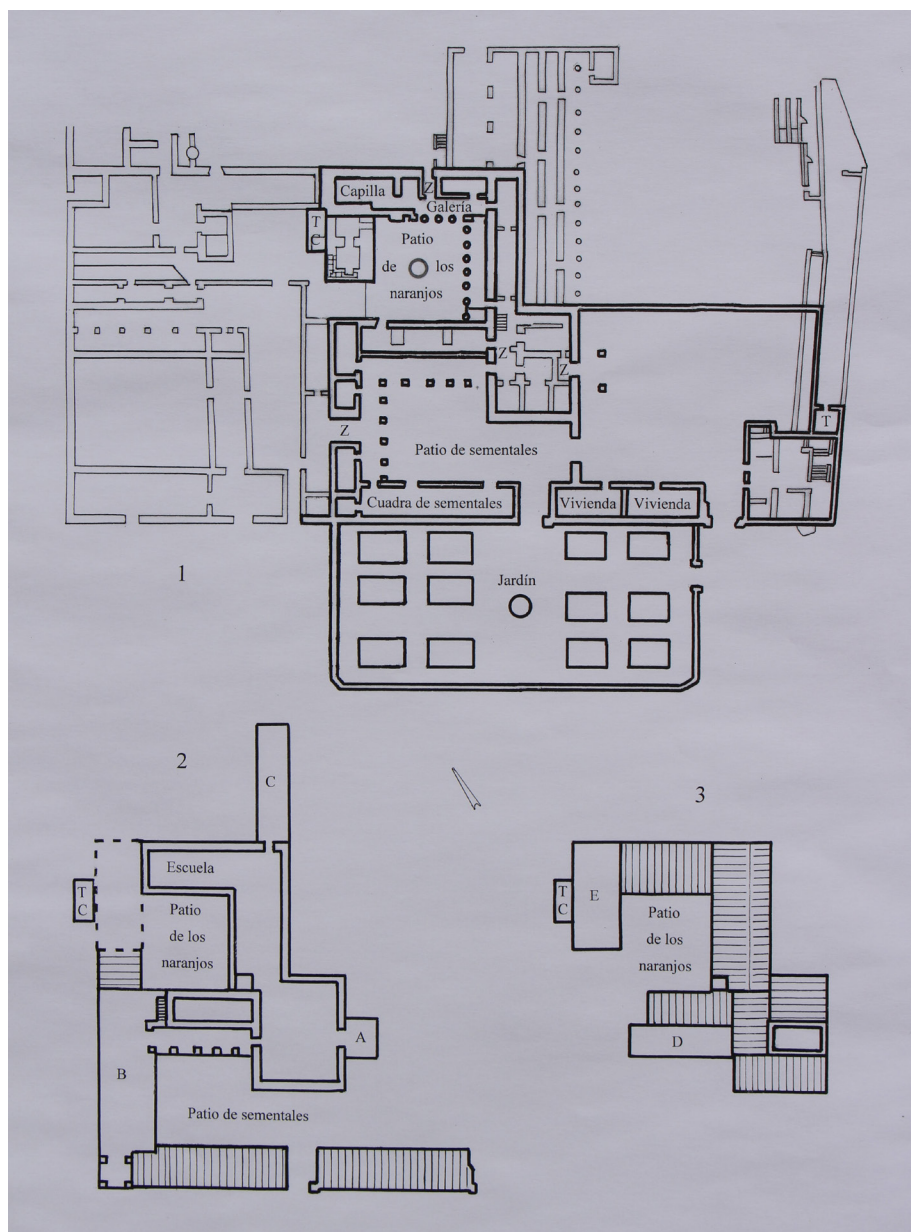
Intervención de Talavera Heredia en el caserío de Gambogaz. 1, planta baja. 2, planta primera. 3, planta segunda. A, B, C, D, E, terrazas; T, torre del transformador; TC, torre contrapeso; Z, zaguán (Elaboración propia).
